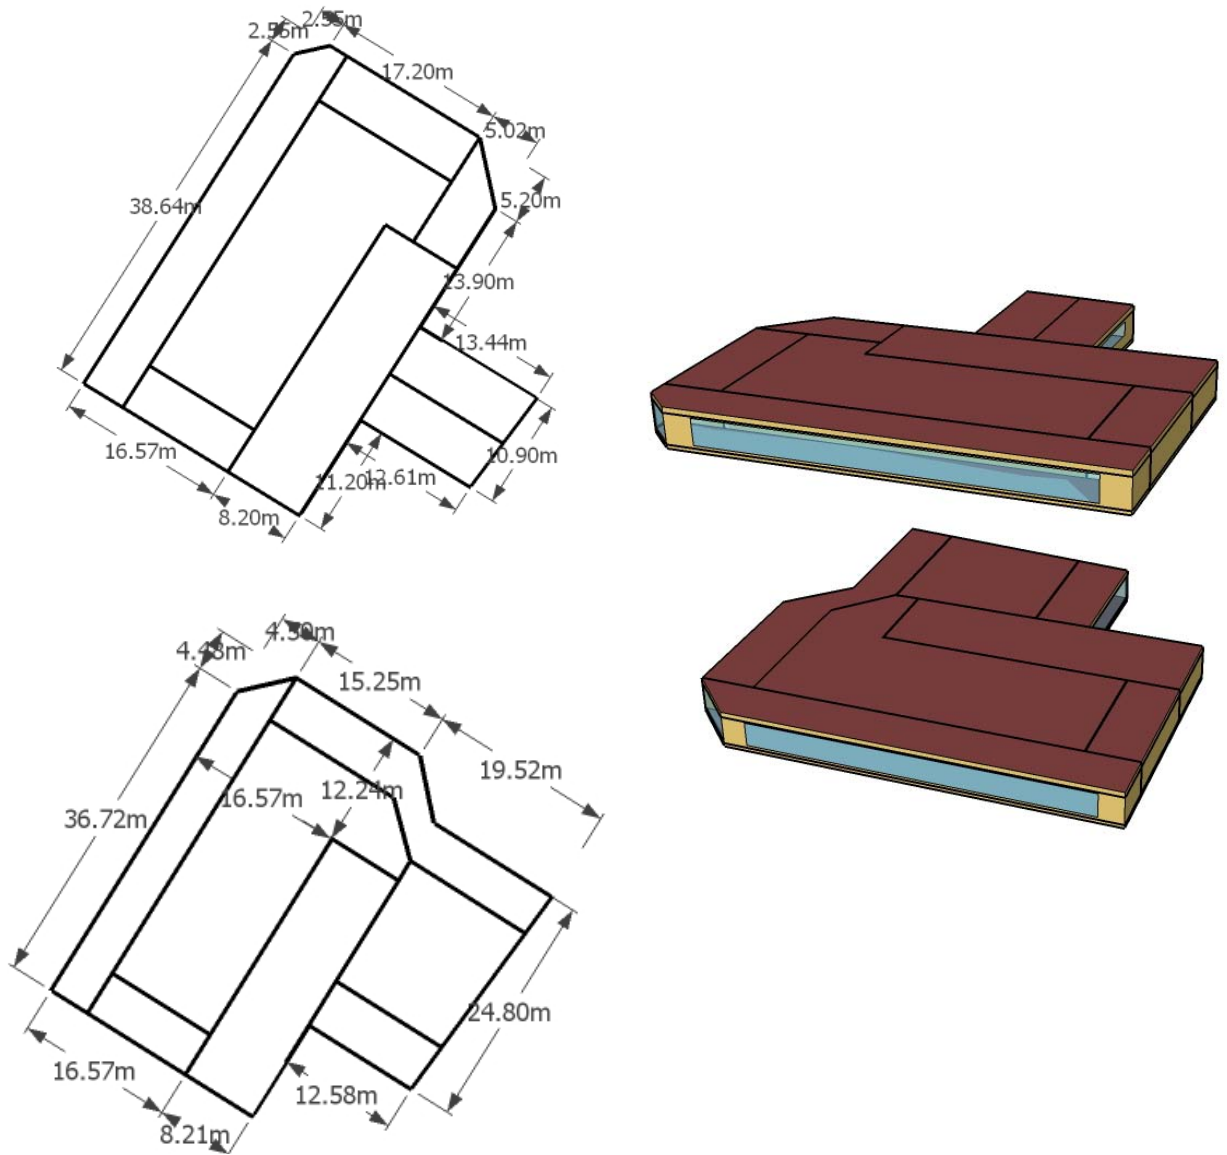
Planta e modelo espacial de pavimentos tipo do Proposed Building para o estudo de caso #9
